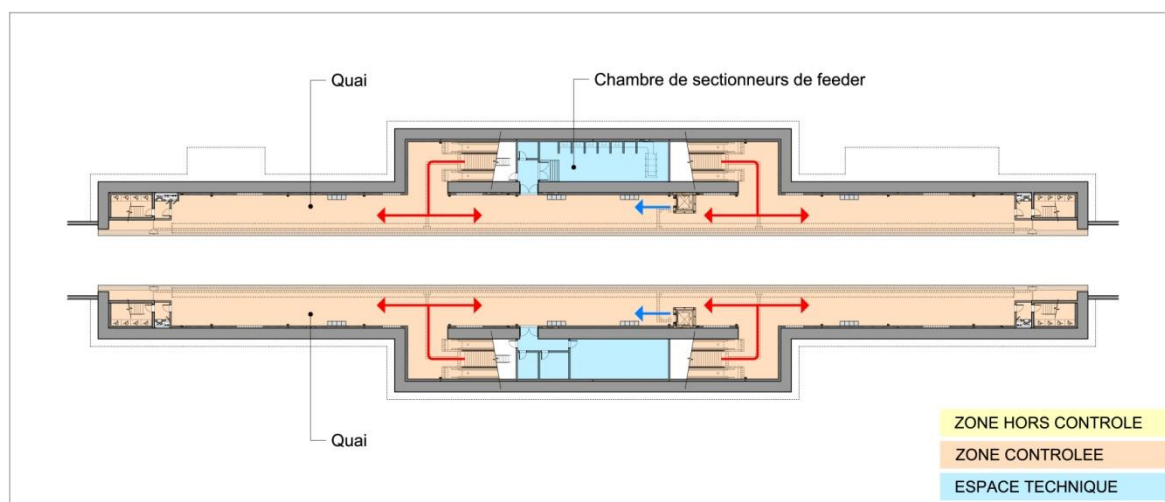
Plan des différentes zones du niveau-2 de la station
